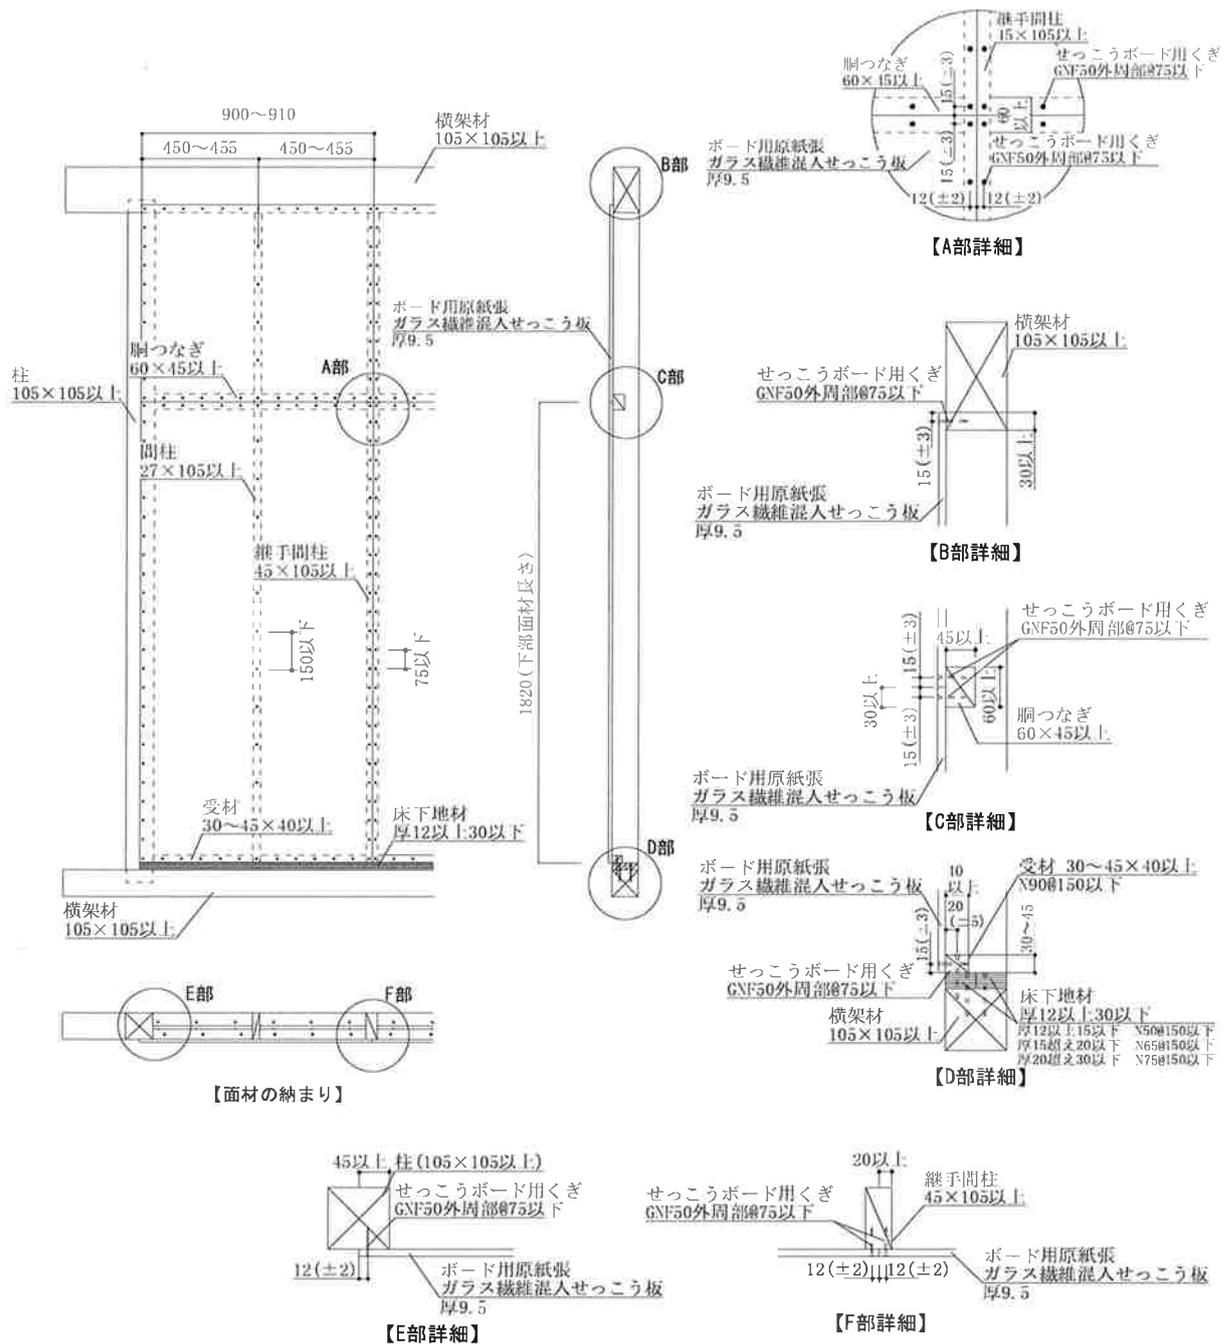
施工図：縦継ぎ張りの場合 (寸法単位：mm)
